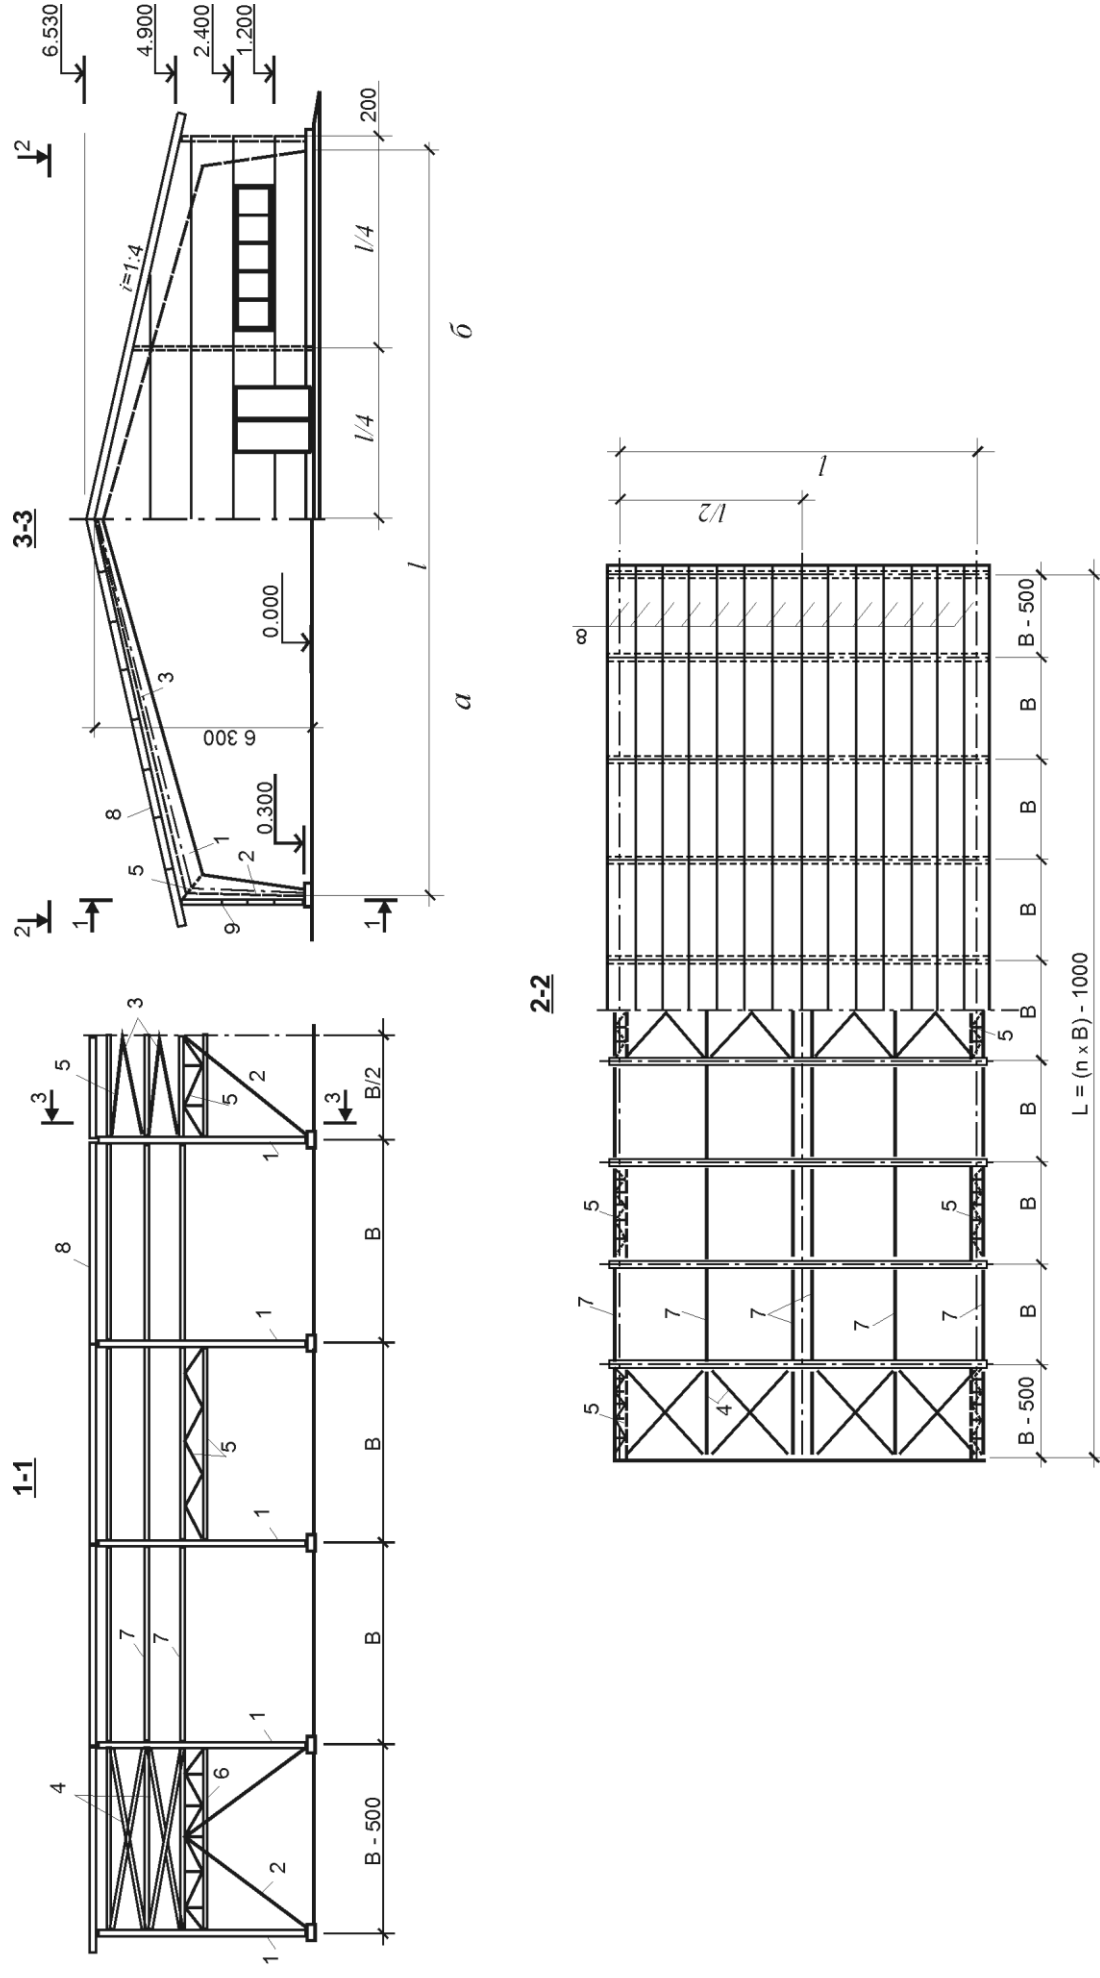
Просторова схема споруди: *a* – поперечний розріз; *б*- торцевий фасад; *в*- плита покриття; 1- рами; 2- вертикальні зв'язки між стойками рам; 4- вітрова ферма; 5, 6- карнизні зв'язувальні ферми; 7- розпірки; 8- плити покриття; 9- стінові панелі;
